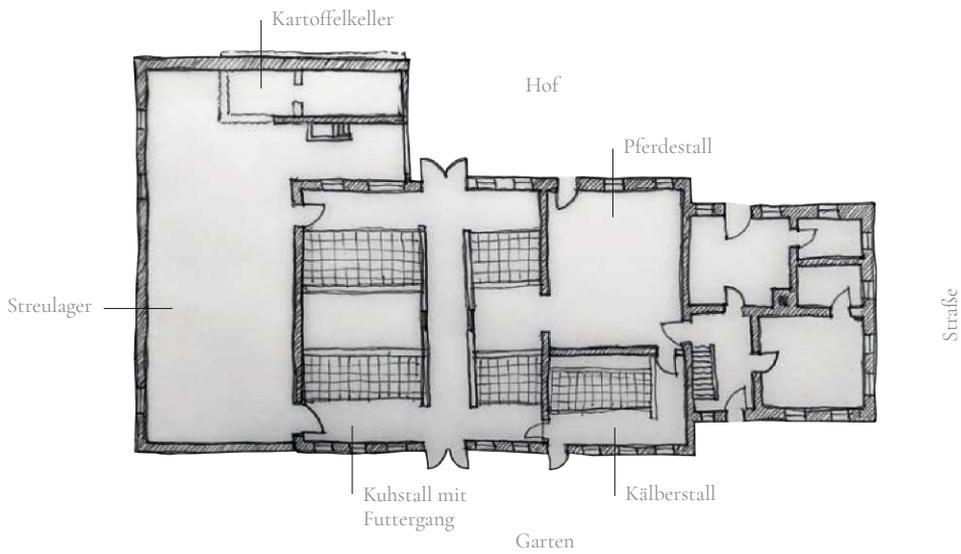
Skizze, Grundriss Wirtschaftstrakt nach Umbau
